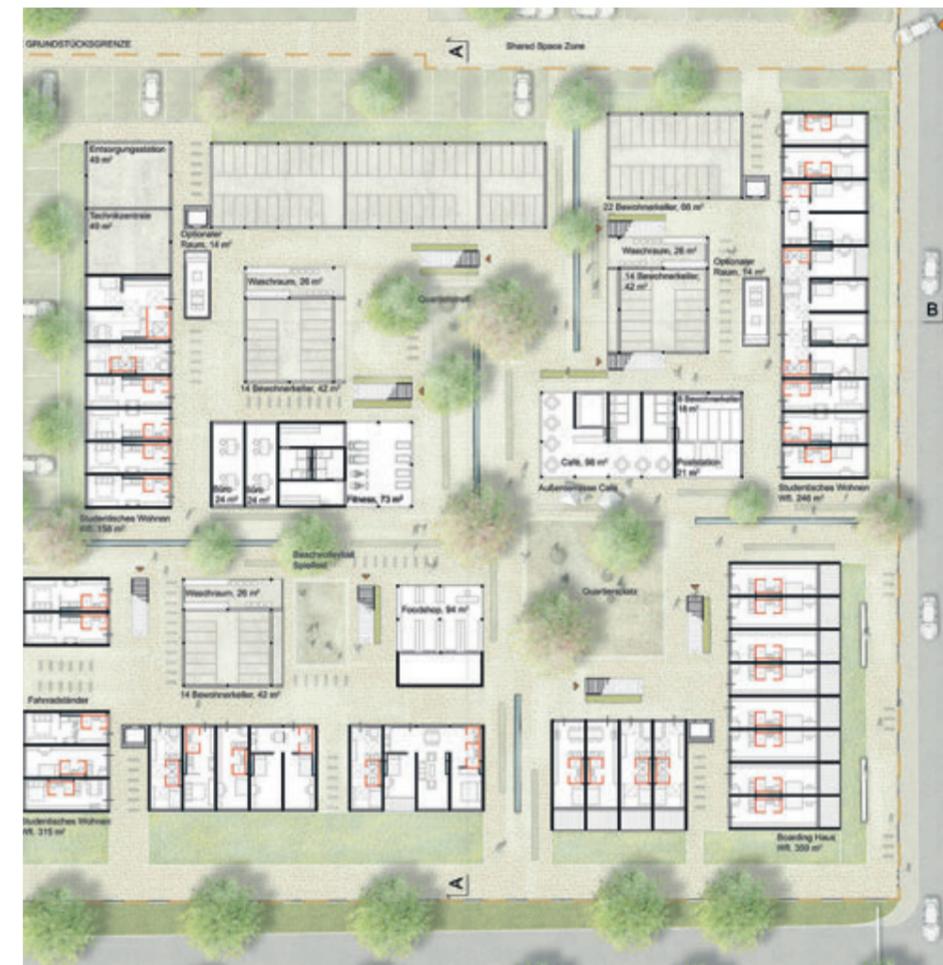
Lageplan Campus RO, ohne Maßstab (ACMS Architekten o.J.)
